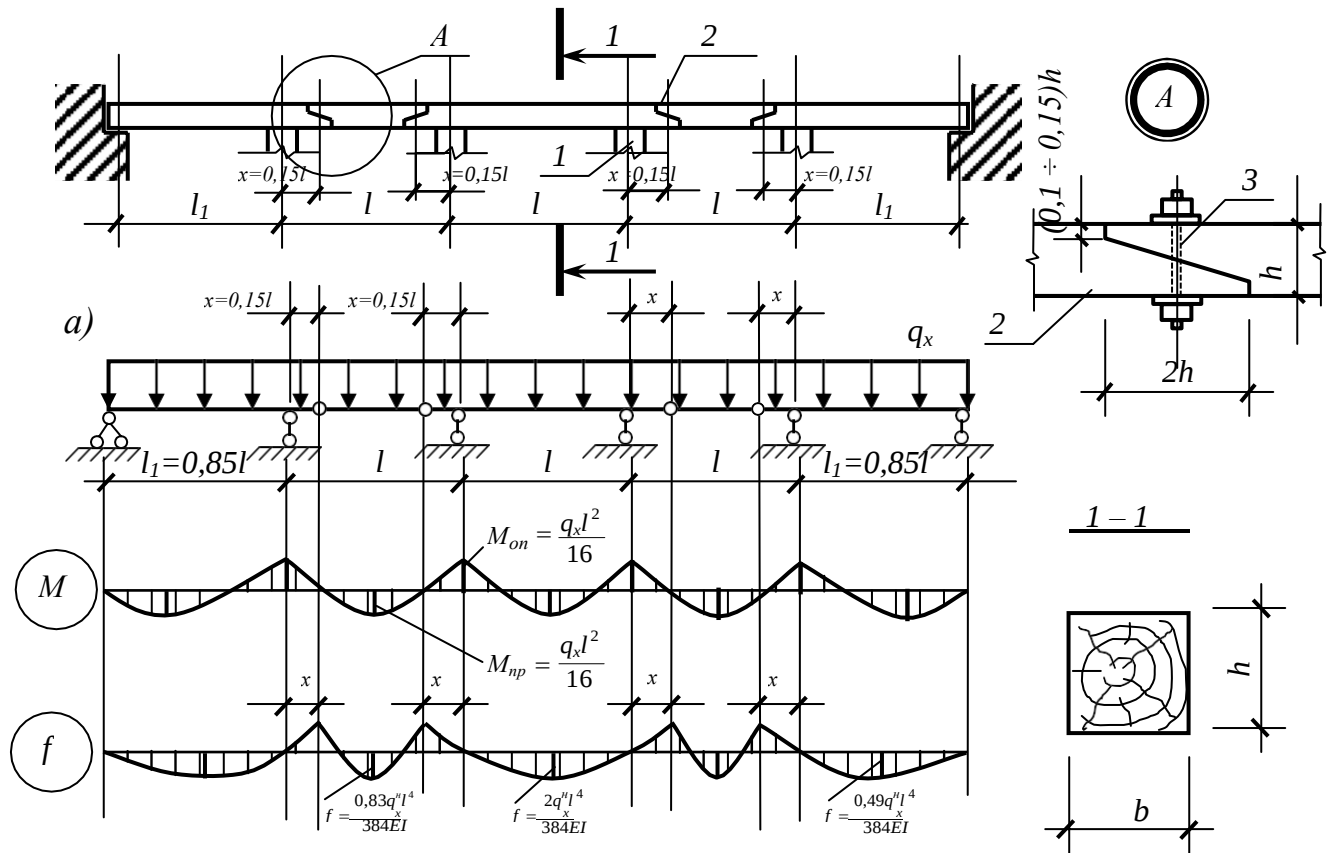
Схема консольно-балочного прогона: а – расчетная схема прогона и эпюры M и f ; 1 – несущая конструкция; 2 – прогоны; 3 – болт
